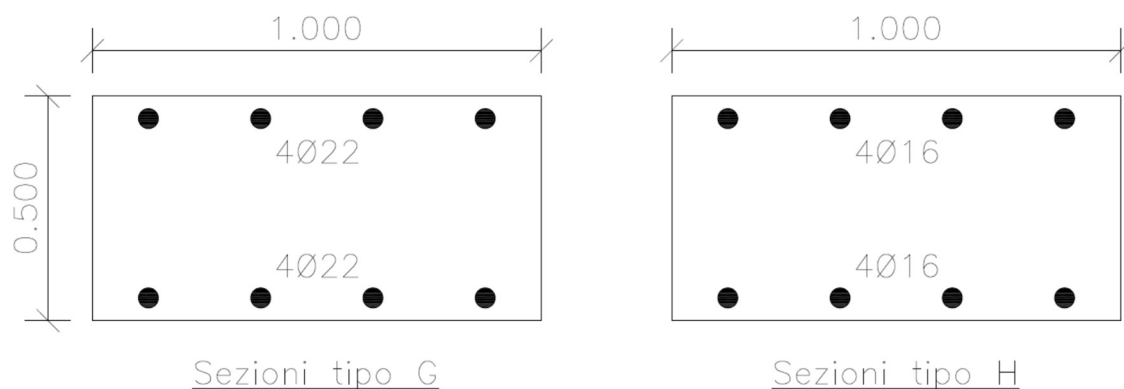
Sezioni rettangolari verticali, alle diverse altezze (G, H), con indicazione delle armature utilizzate
